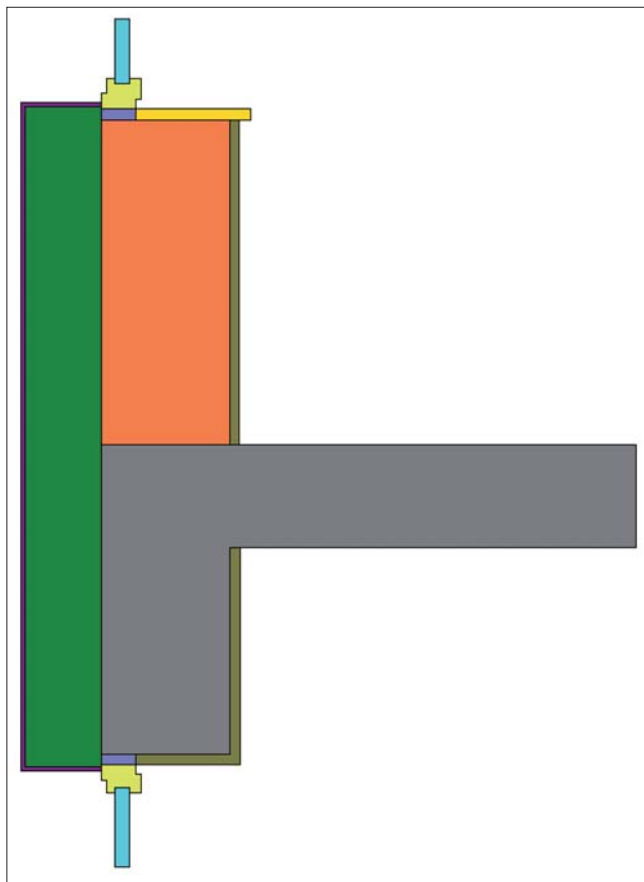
Схема вертикального разреза стены с теплоизолированным фасадом в зоне расположения светопроемов с оконными блоками
